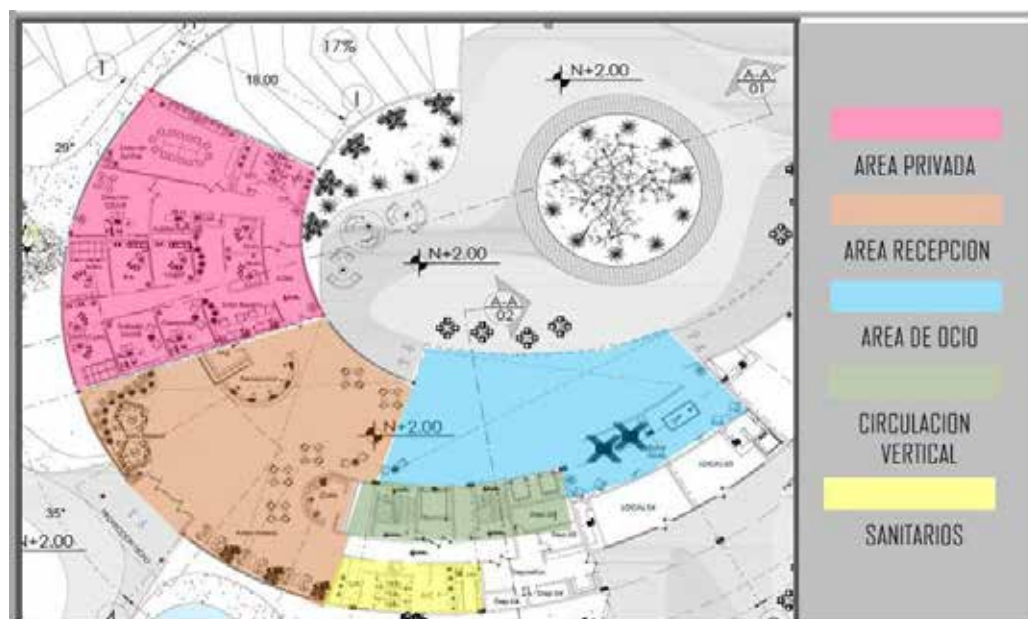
Edificio A, Planta Baja – Zona privada con sus Áreas. Fuente: De Andrade. (2018)
